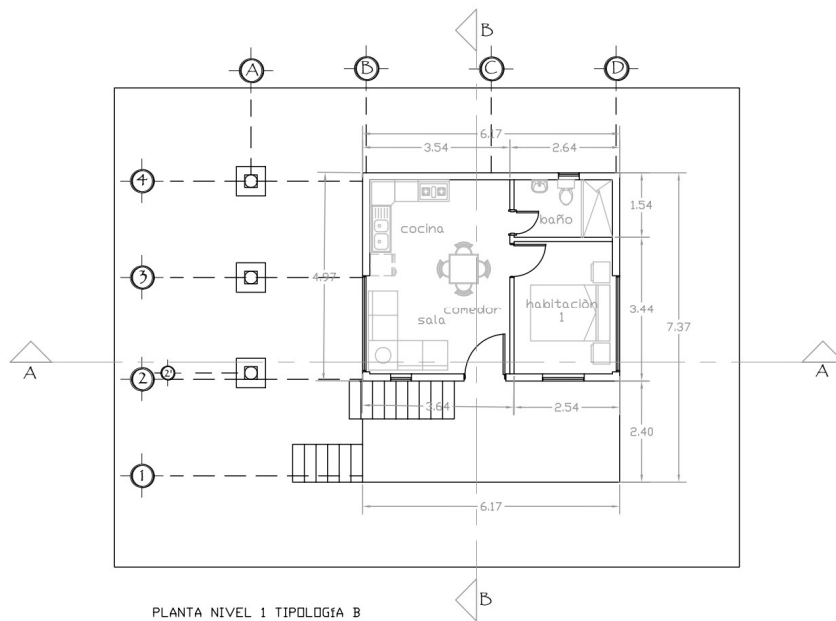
Planta Primer Nivel Tipología - B - Elaboración propia
